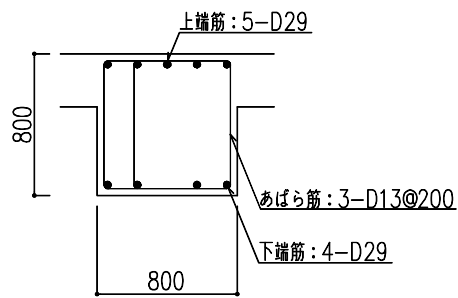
大ばりの配筋図 (屋上階, X2 通り YK~YL 通り間, 端部) (単位: mm)
